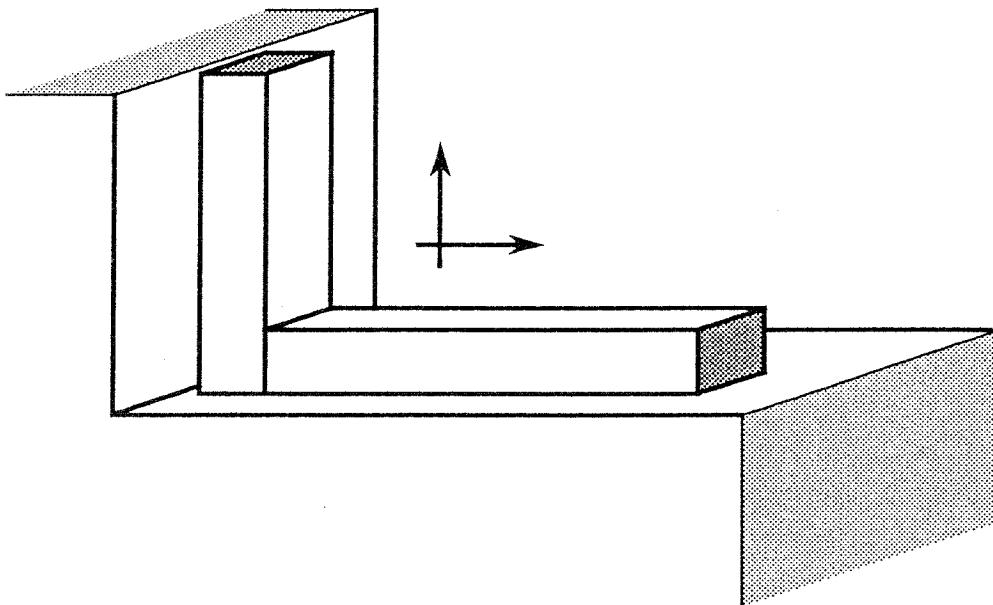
Sicherstellung einer winkeltgerechten Fensteröffnung bei einschaliger Außenwand
